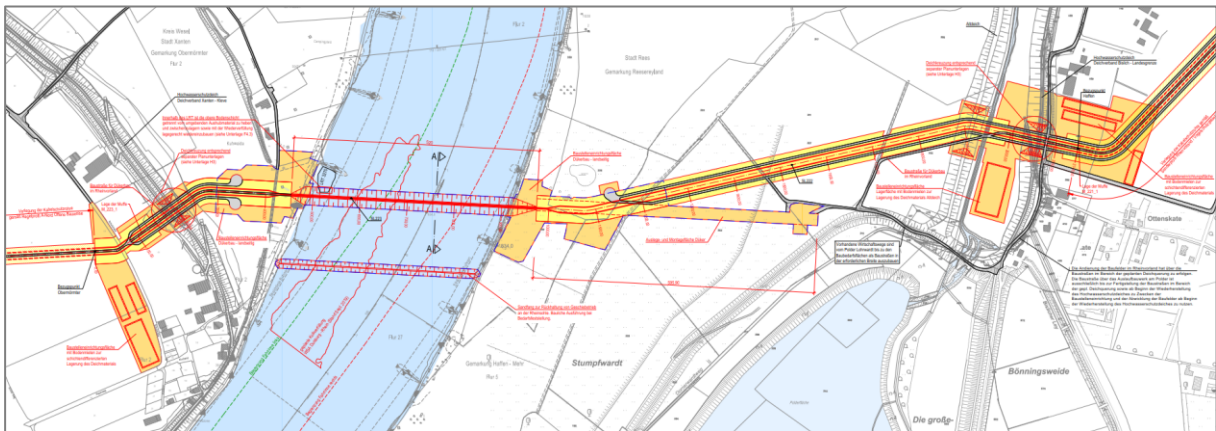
Rheinquerung Alternative 1 - Offene Bauweise – Lageplan
